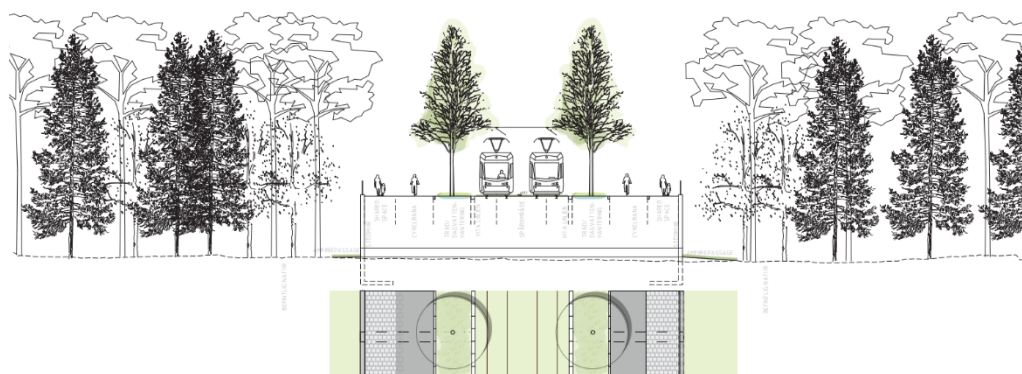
Sektion med planillustration av alternativ utformning av marknära brokonstruktion. Gatan och kollektivtrafiken går på en bank som istället för slänter avgränsas med stödmurar med ett underliggande tunnelsystem för amfibier. Bild: White arkitekter.
